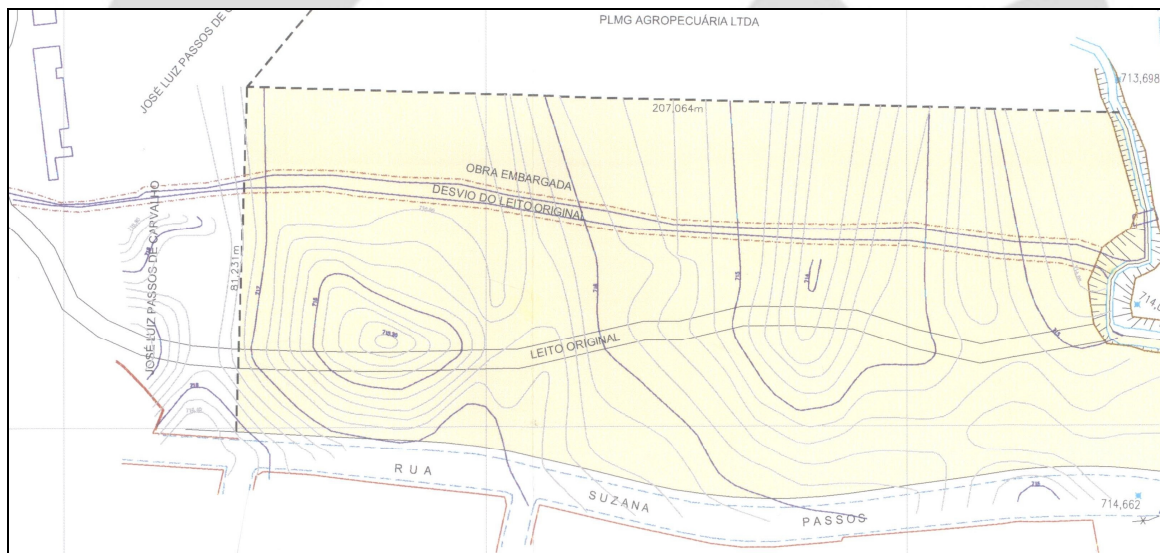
Planta da intervenção proposta (obra embargada) e leito original
